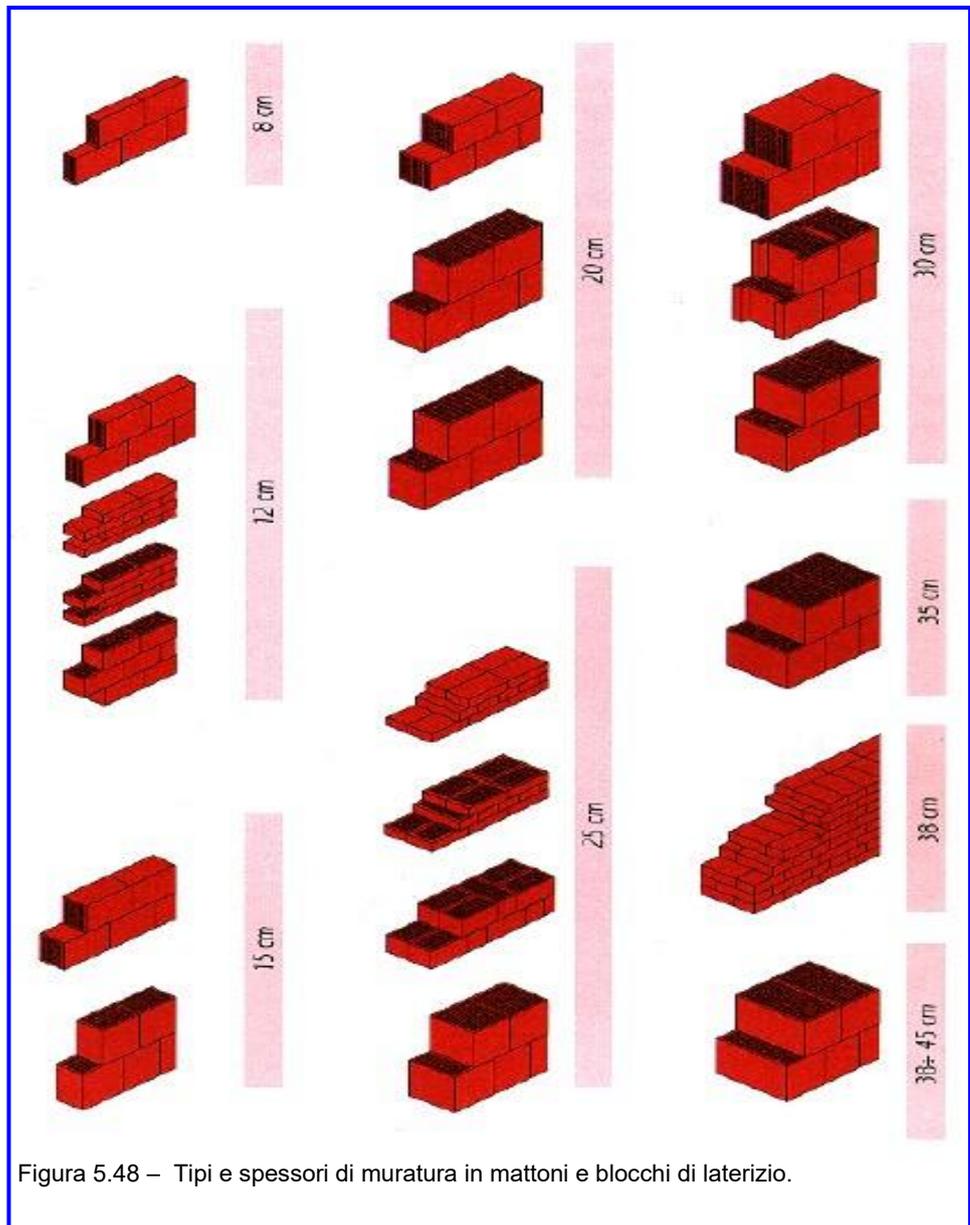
Tipi e spessori di muratura in mattoni e blocchi di laterizio.
